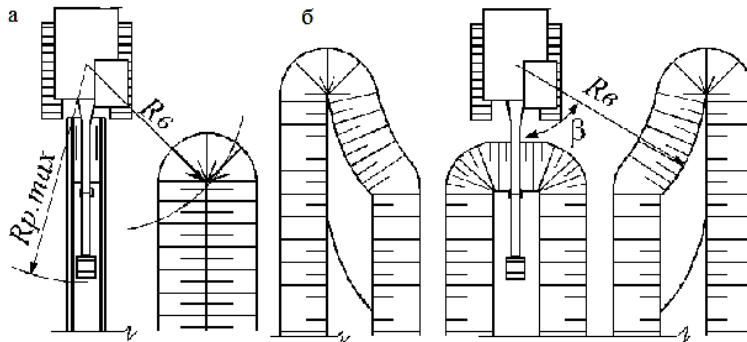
Схеми розроблення виїмок одноківшовим екскаватором, обладнаним зворотною лопатою: а – траншеї; б – каналу
